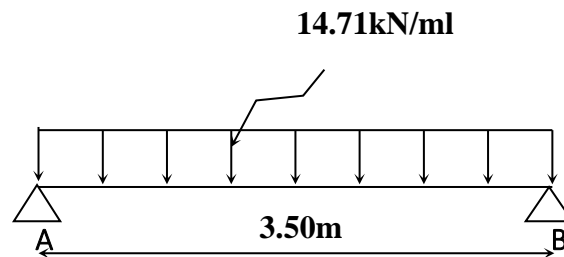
Schéma statique de la poutre de chaînage à l'ELU.
